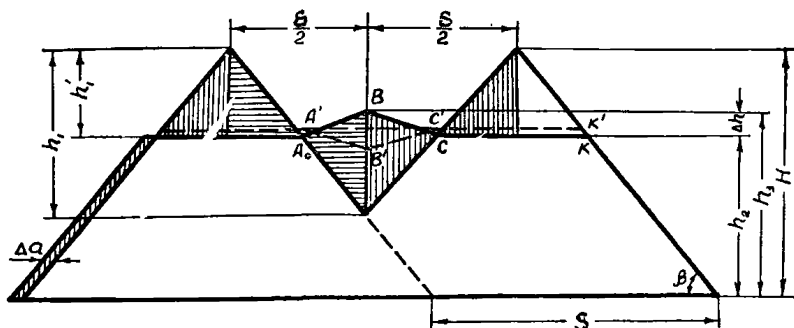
Расчетная схема к определению планировки отвалов с большими перепадами высотных отметок.
